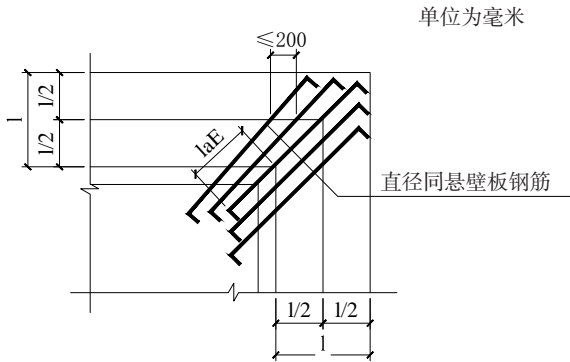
屋面板挑檐转角处构造钢筋示意
